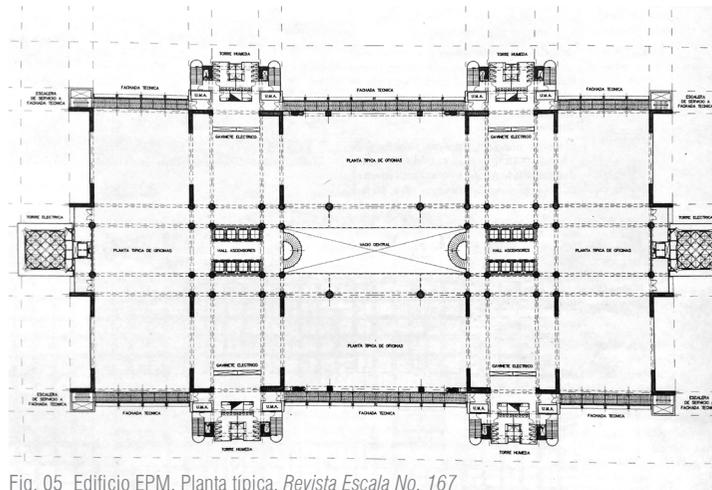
\_Edificio EPM. Planta típica. Revista Escala No. 167
